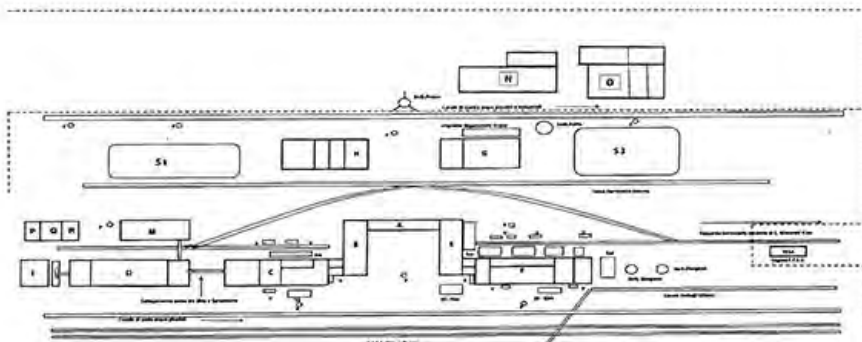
Planimetria stabilimento Seriom nel 1964, con impianto Oleochimico
